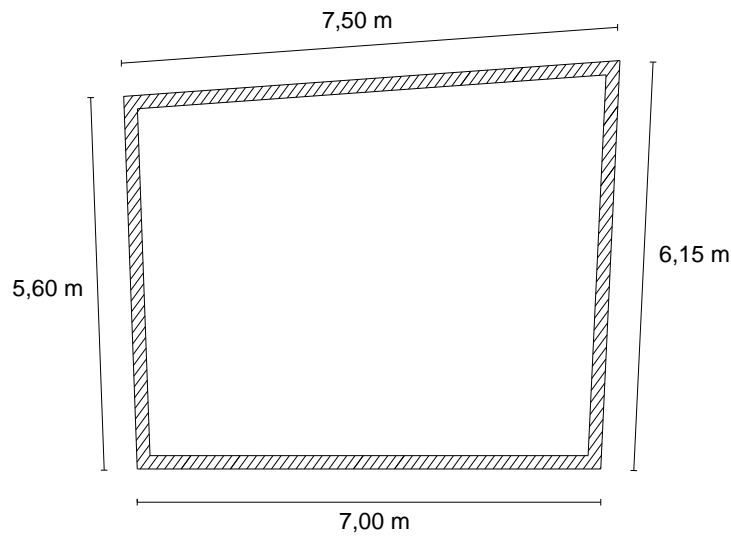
Planta (esquema) da câmara reverberante R1 da FEUP
